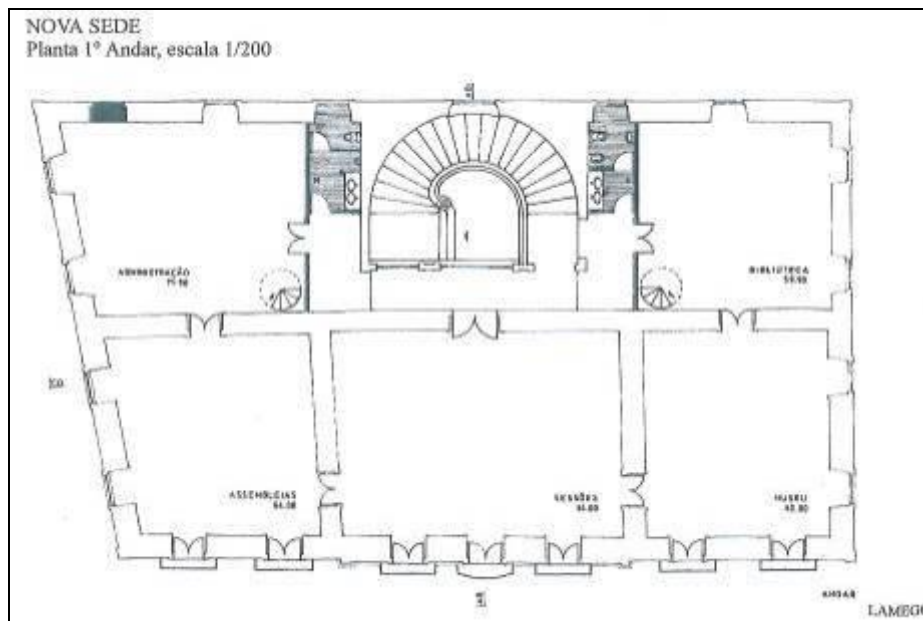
Planta do 1.º andar da casa dos Pereira Coutinho / casa dos Vilhenas (sede da Santa Casa de Misericórdia). Escala1/200<sup>541</sup>.
